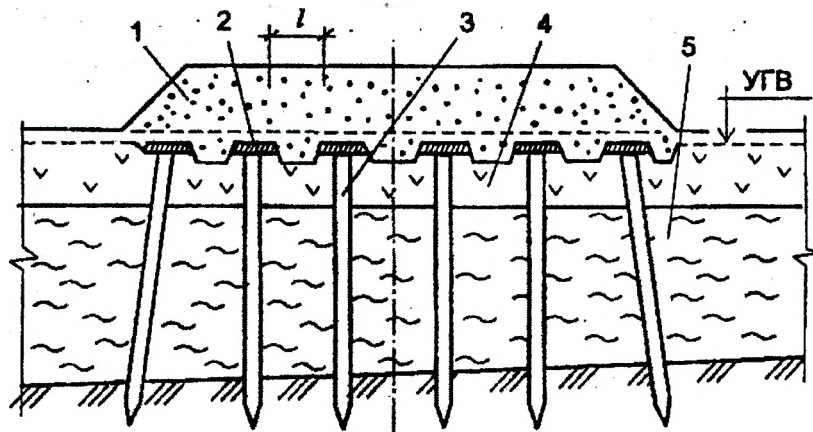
Насыпь на сваях ростверкового типа: 1 – насыпь; 2 – бетонные наголовники; 3 – деревянные сваи; 4 – торф; 5 – листовой грунт
